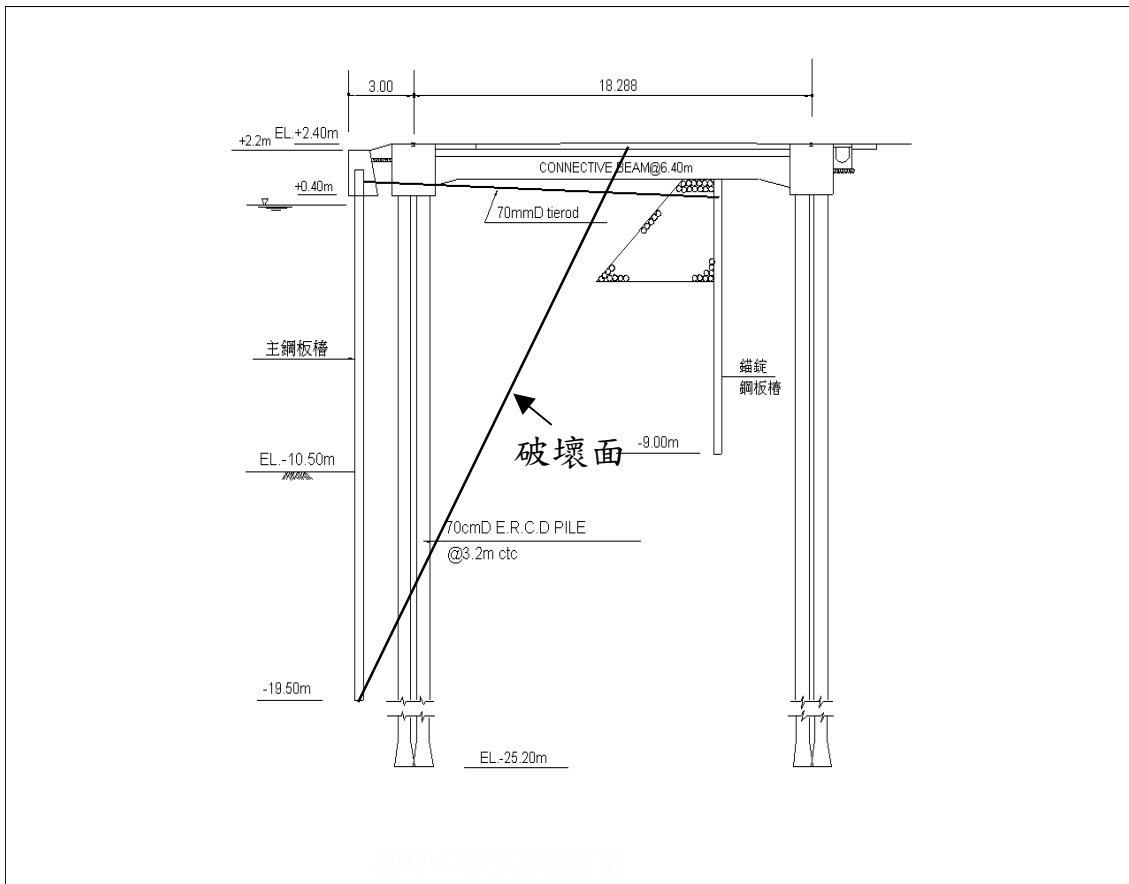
板樁式碼頭（後線打設基樁）主動破壞面示意圖
